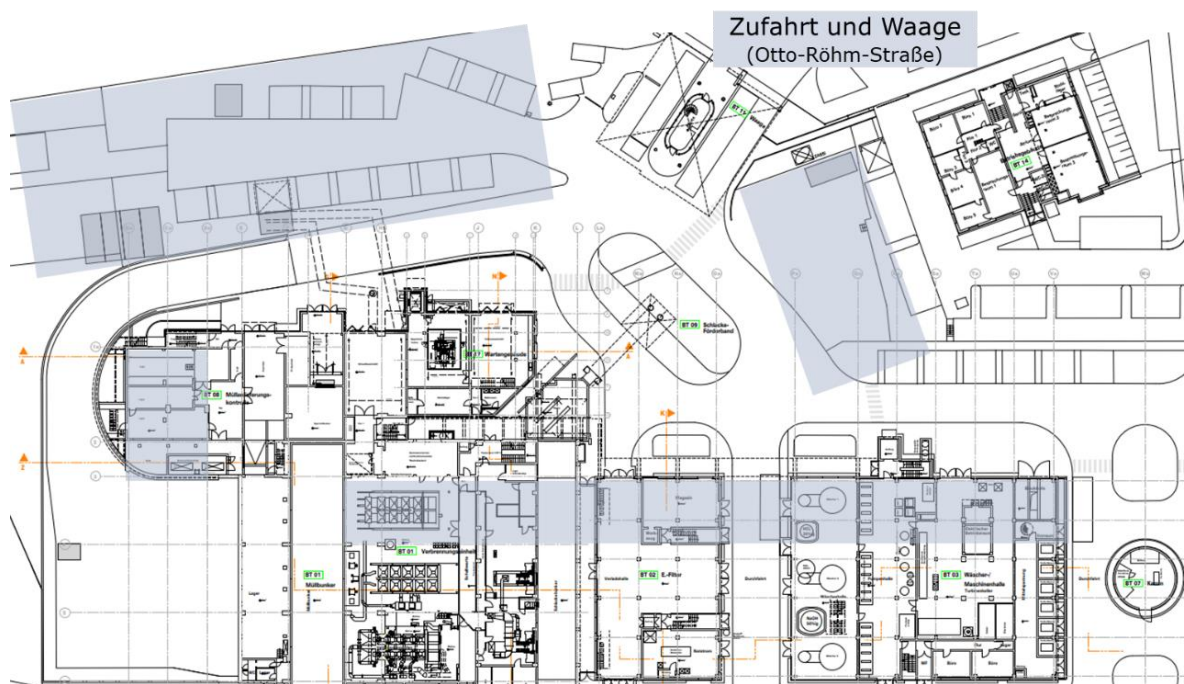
Lageplan des MHKW mit möglichen Baufeldern für die Klärschlammbehandlung
